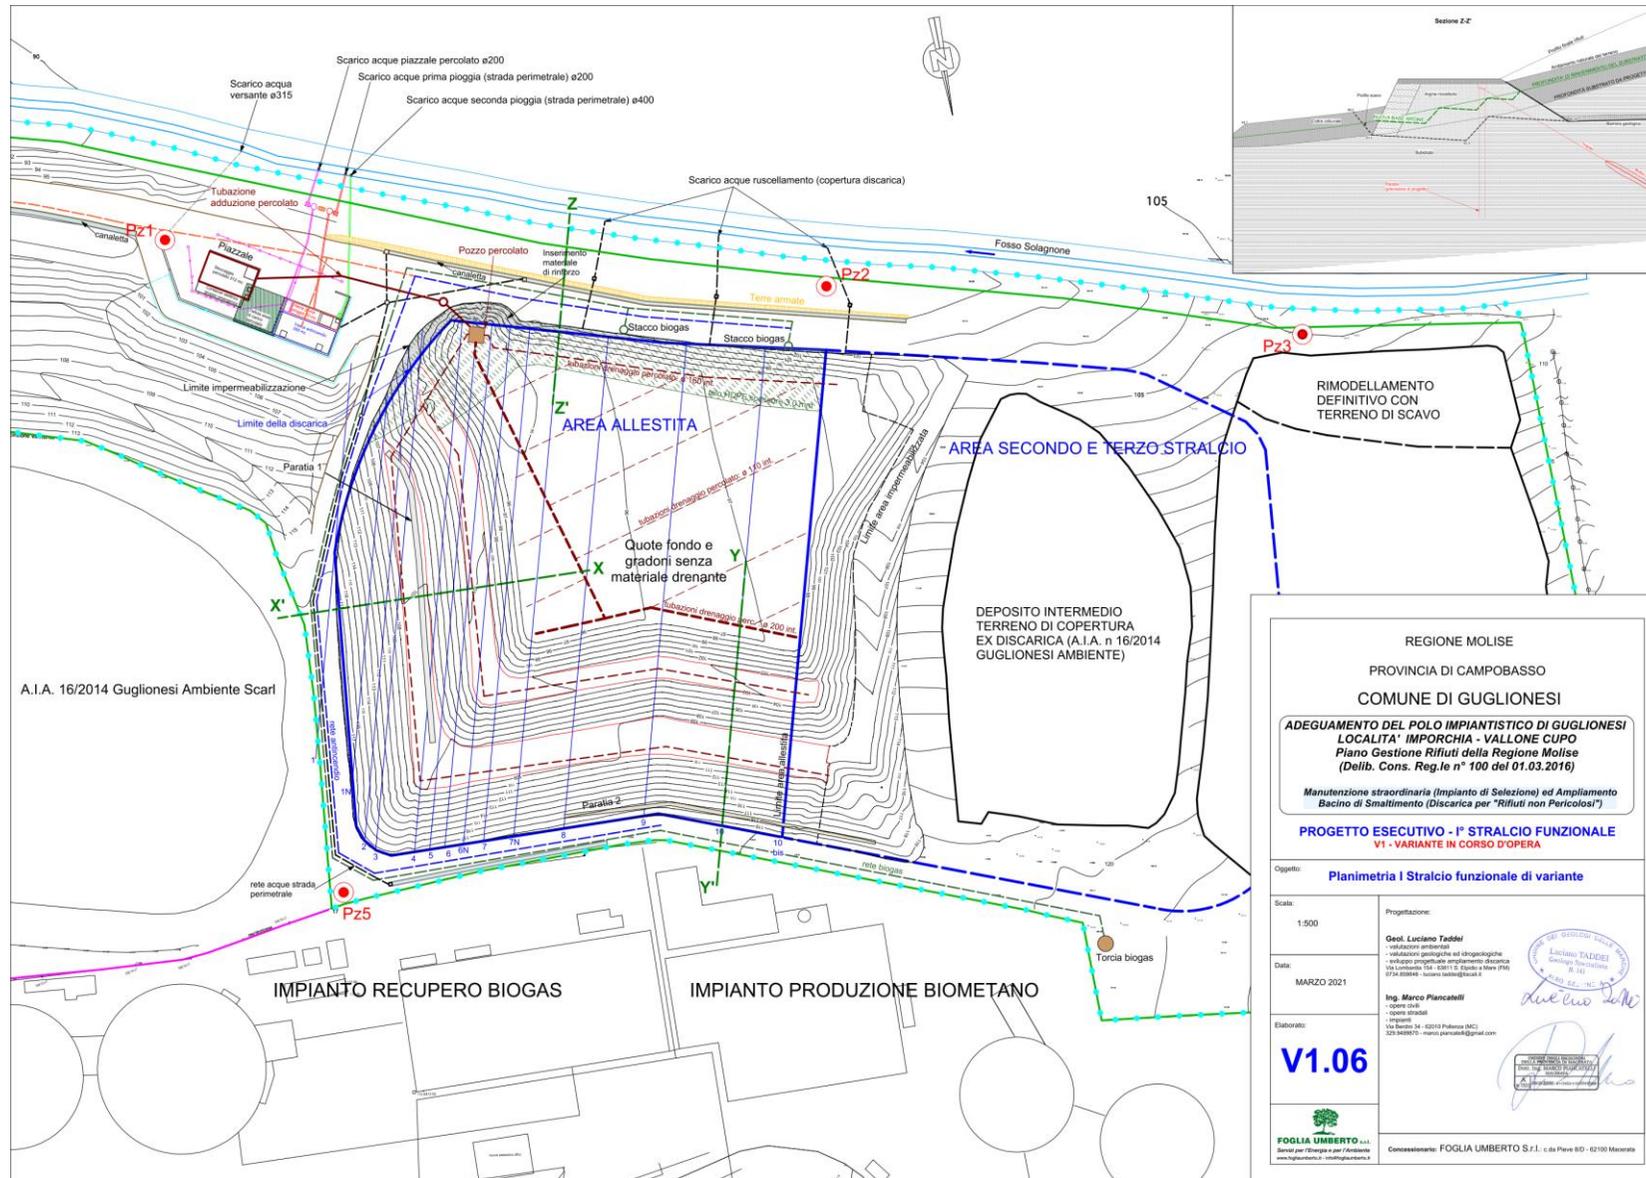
planimetria generale del 1° stralcio funzionale: assetto "post operam"
